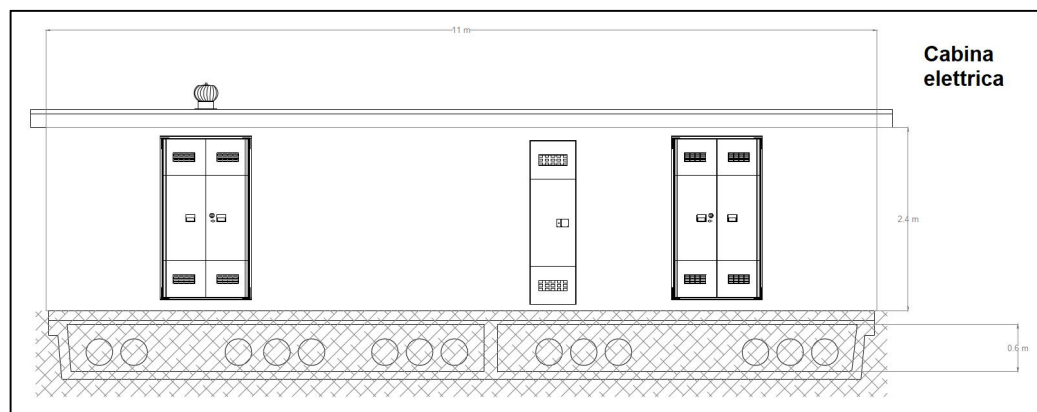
Prospetto della cabina elettrica con la profondità di scavo della fondazione.
